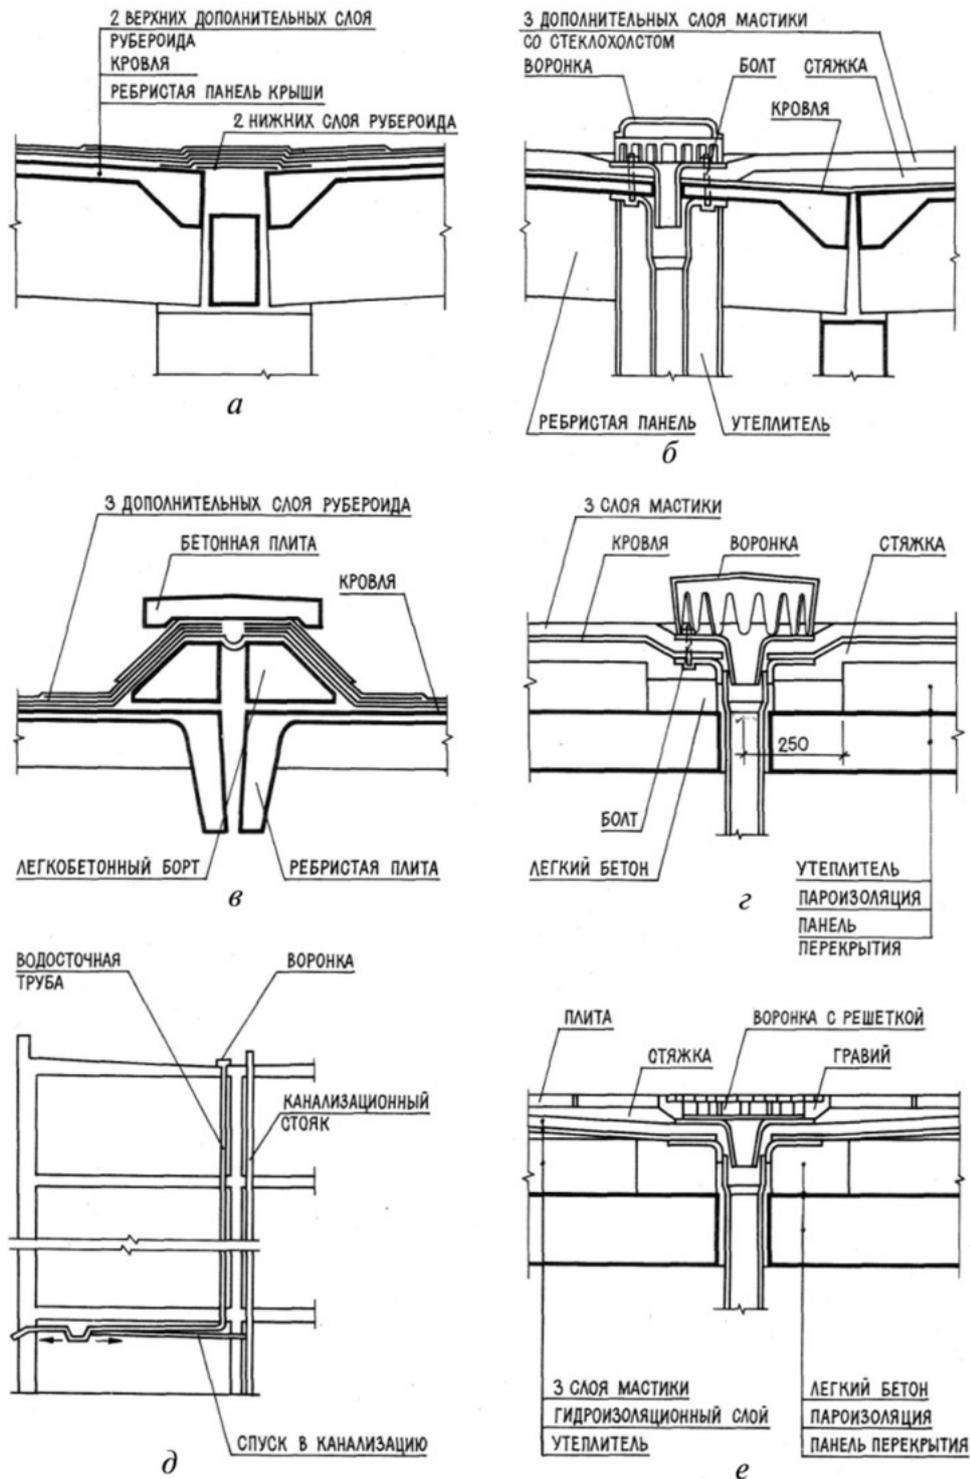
Детали кровли и водостоков: *a* - деталь кровли в ендове; *б* — крепление воронки внутреннего водостока при ребристых панелях раздельной крыши; *в* — деформационный шов крыши из ребристых панелей и примыкание к нему кровли; *з* — водосток совмещенной крыши; *д* - схема внутреннего водостока с наружным выпуском; *е* — водосточная воронка на эксплуатируемой крыше двухслойных панелей применяют легкие бетоны плотностью 800—1200 кг/м³ класса В3,5 — В7,5, для трехслойных — эффективные утеплители плотностью менее 300 кг/м³.
